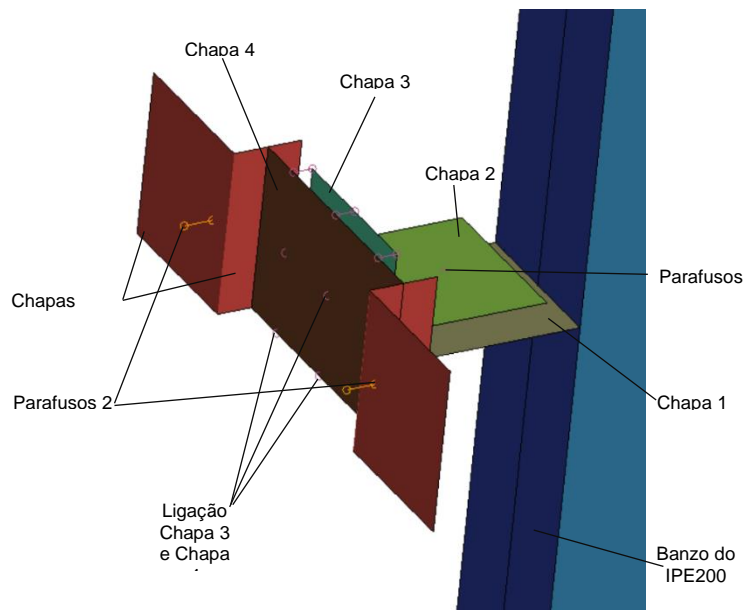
Sistema de fixação da fachada envidraçada do caso de estudo.
